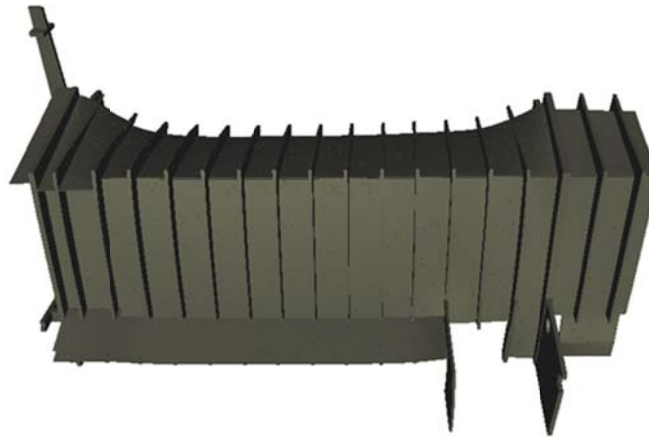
Deformación de la Lámina Sur. Vista exterior
